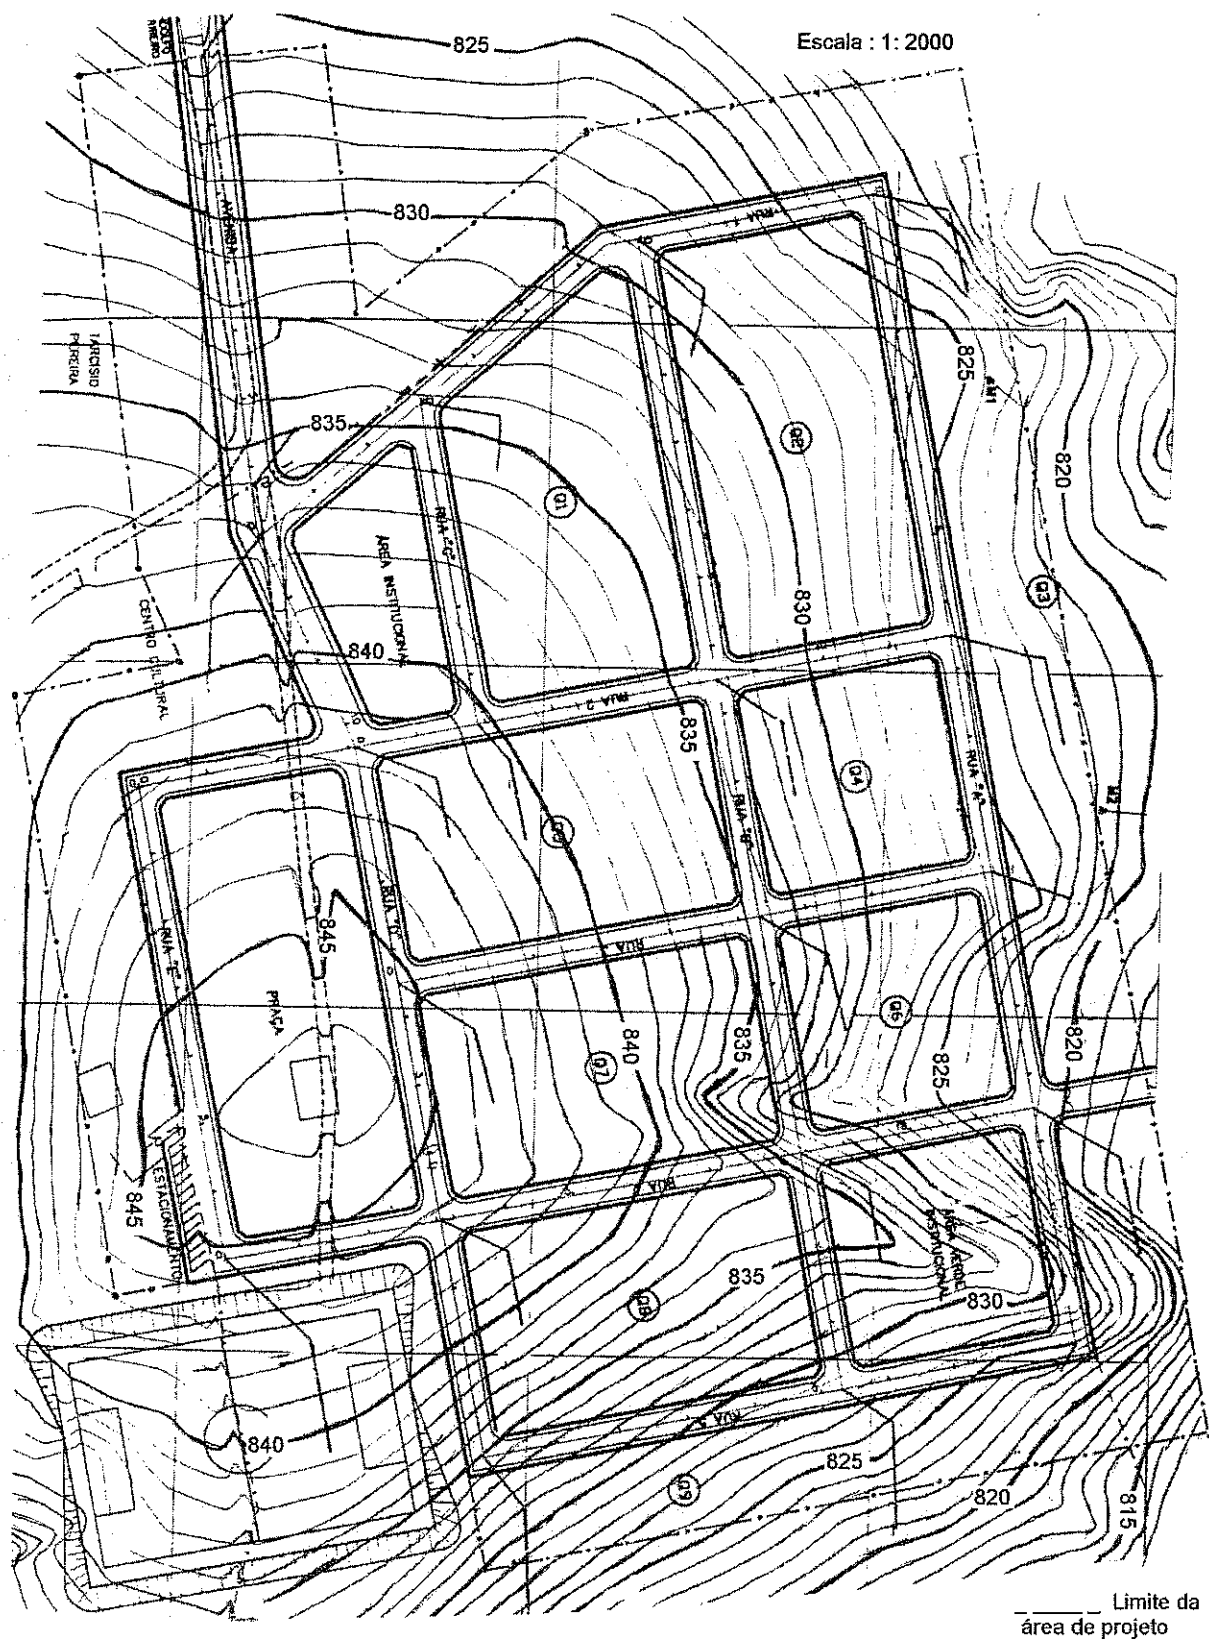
Planta topográfica da vila objeto do Exemplo 14.3
